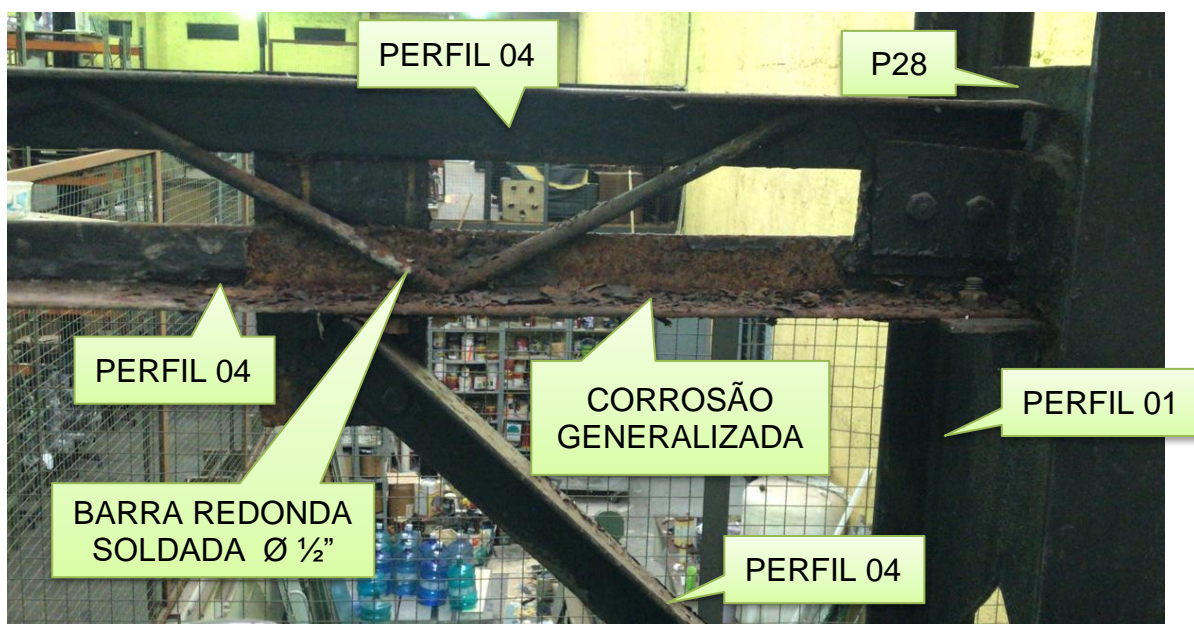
TRAVAMENTO ENTRE P27 E P28
